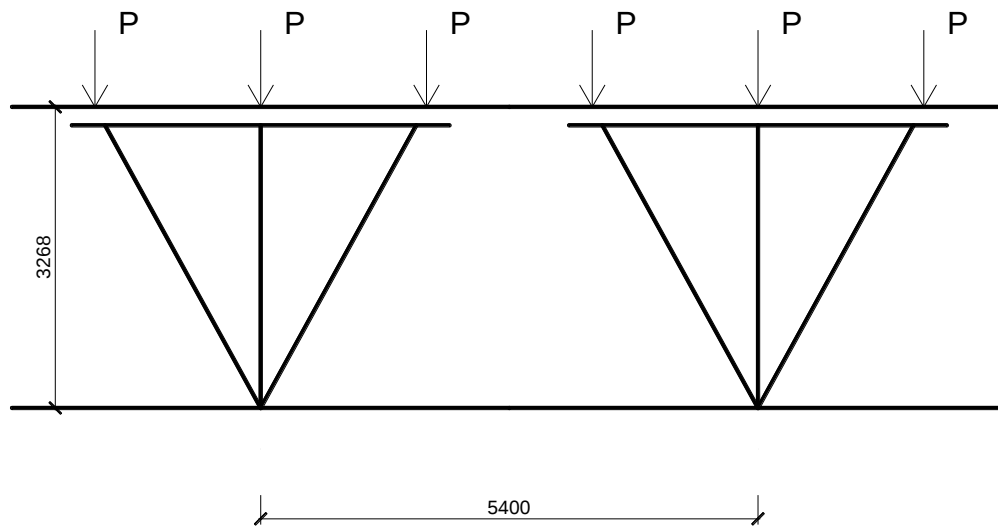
Розрахункова схема підкрюквяних конструкцій
